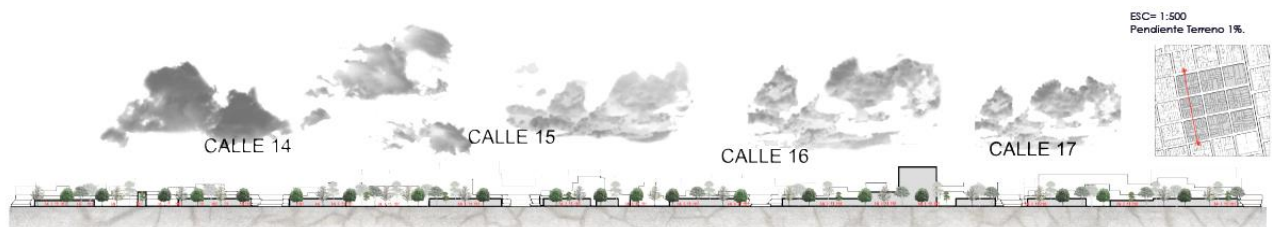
Sección transversal C de área de intervención. Fuente: elaboración propia.
